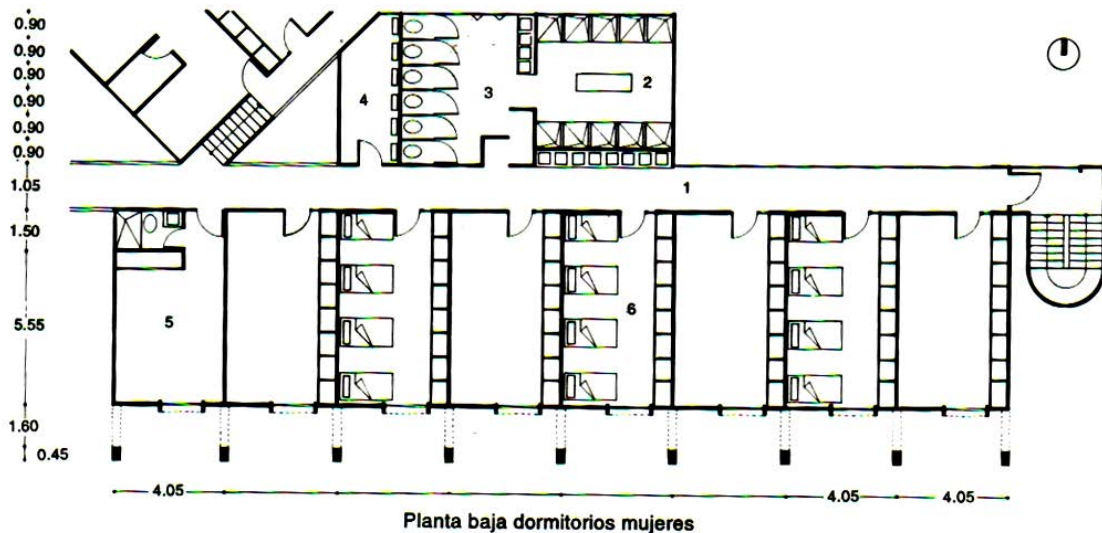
Planta baja de dormitorios Casa Hogar para Niños Irma Arellano.
